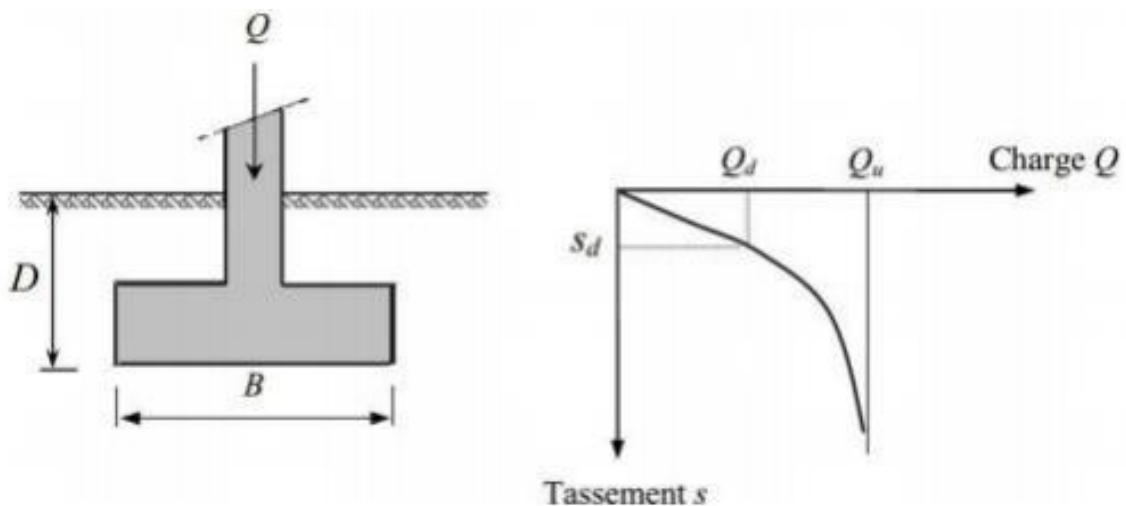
Chargement d'une fondation superficielle (Terzaghi, 1943)
